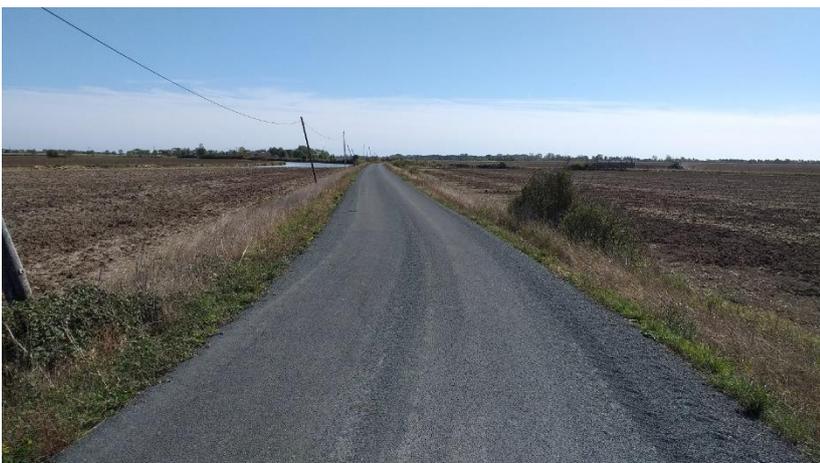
Passage de la conduite à l'Ouest du chemin de desserte locale (à droite sur la photo)
